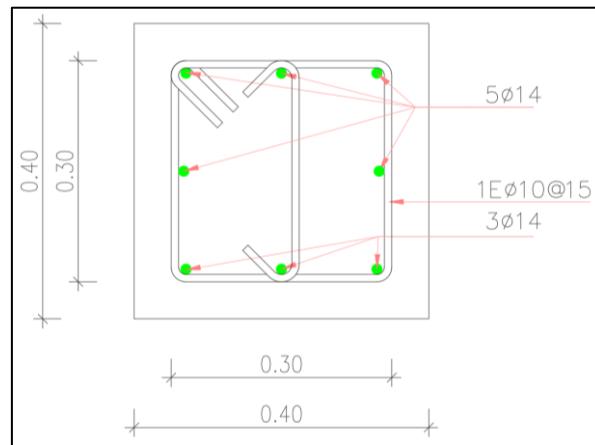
Diseño definitivo de la viga rigidizadora. Fuente: Autor
